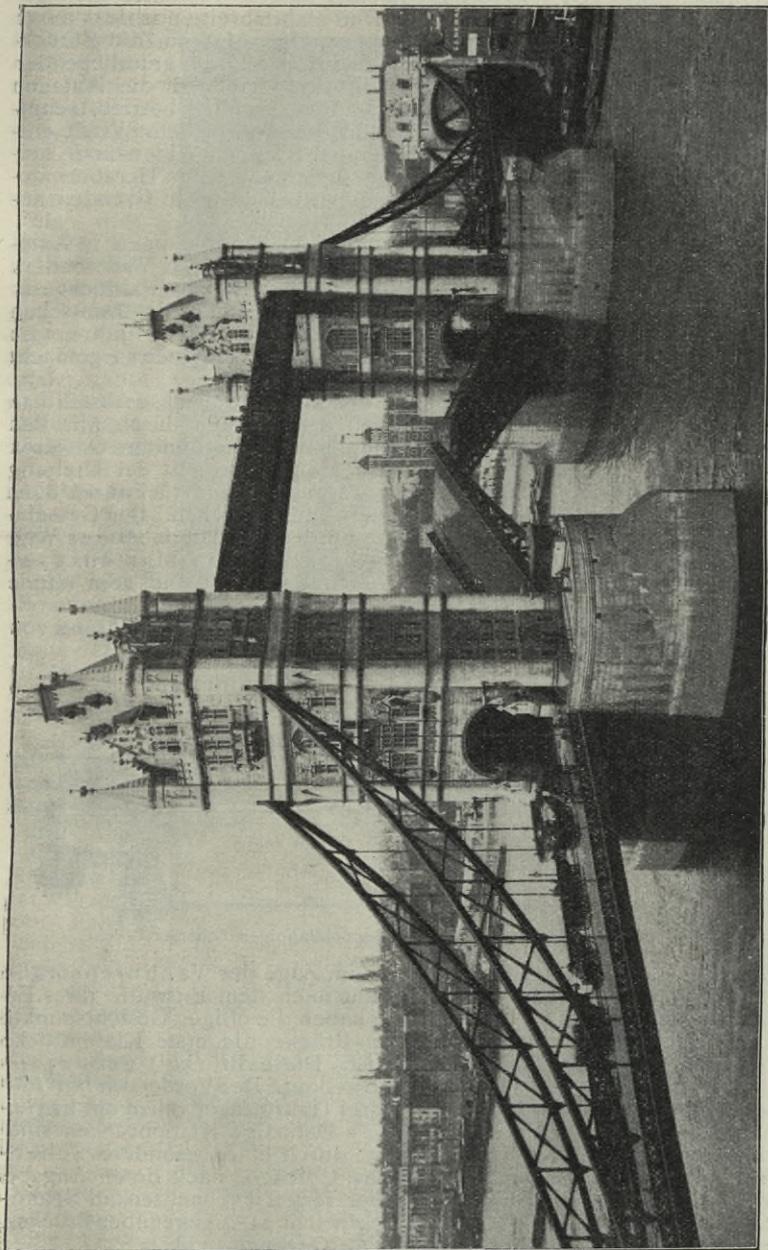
Towerbrücke über die Themse in London. Hängebrücke mit Klappen-Durchfahrt.
